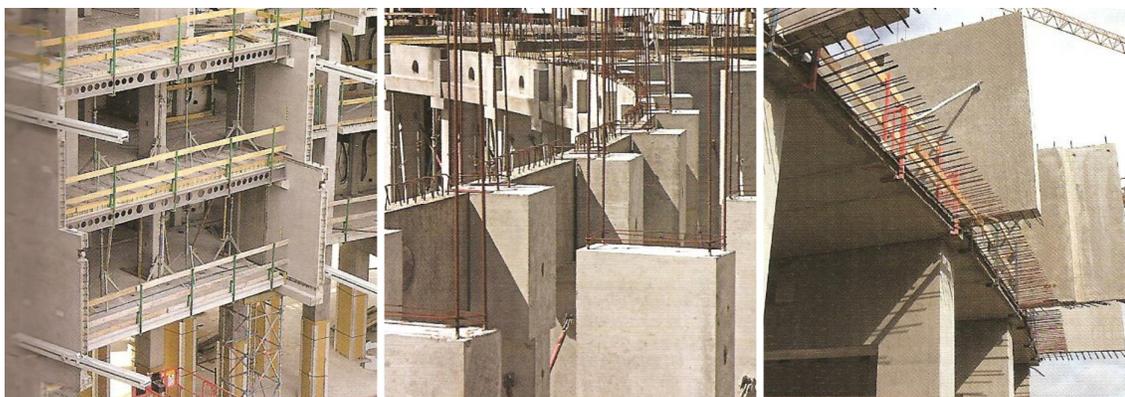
Fotos da construção, mostrando o uso de armaduras e estrutura metálicas
